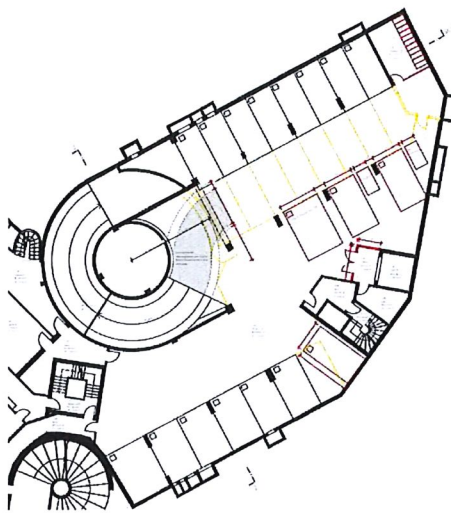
; Ausschnitt Grundriss 1. UG
